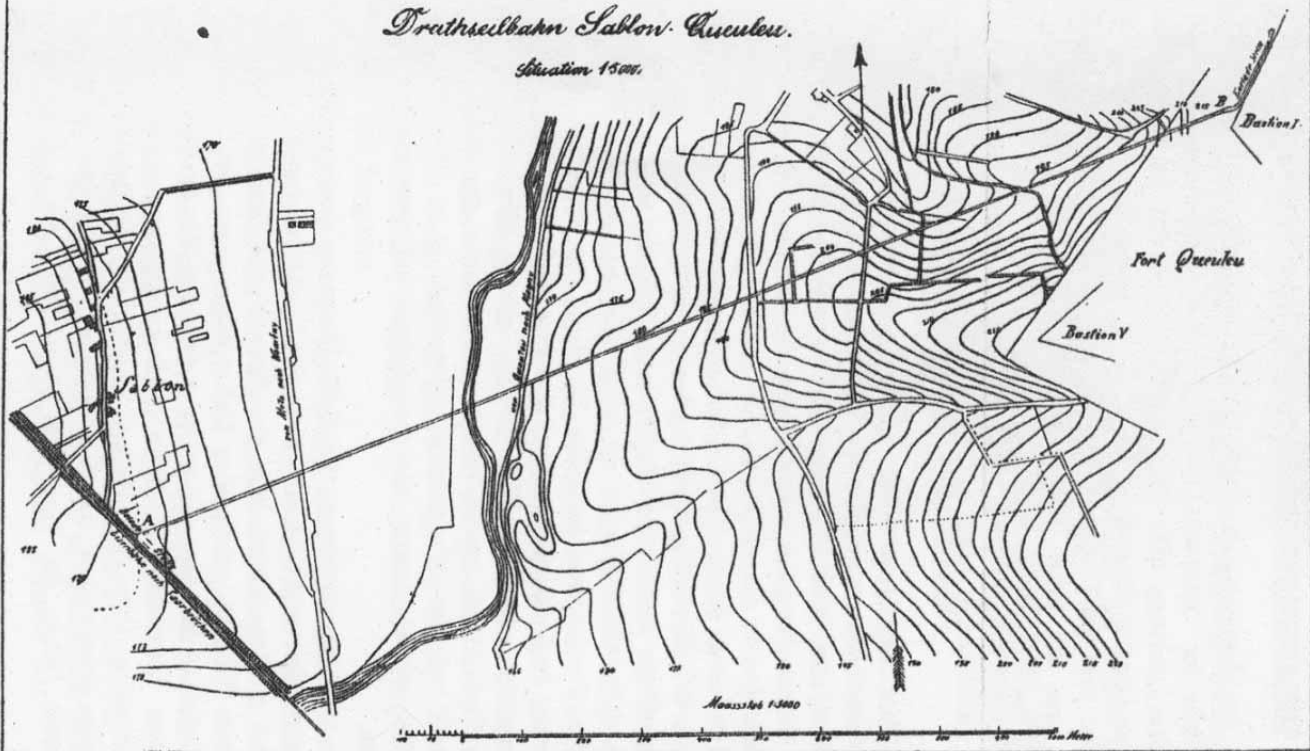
Lageplan der Dückerschen Drahtseilbahn bei Metz, 1871.
